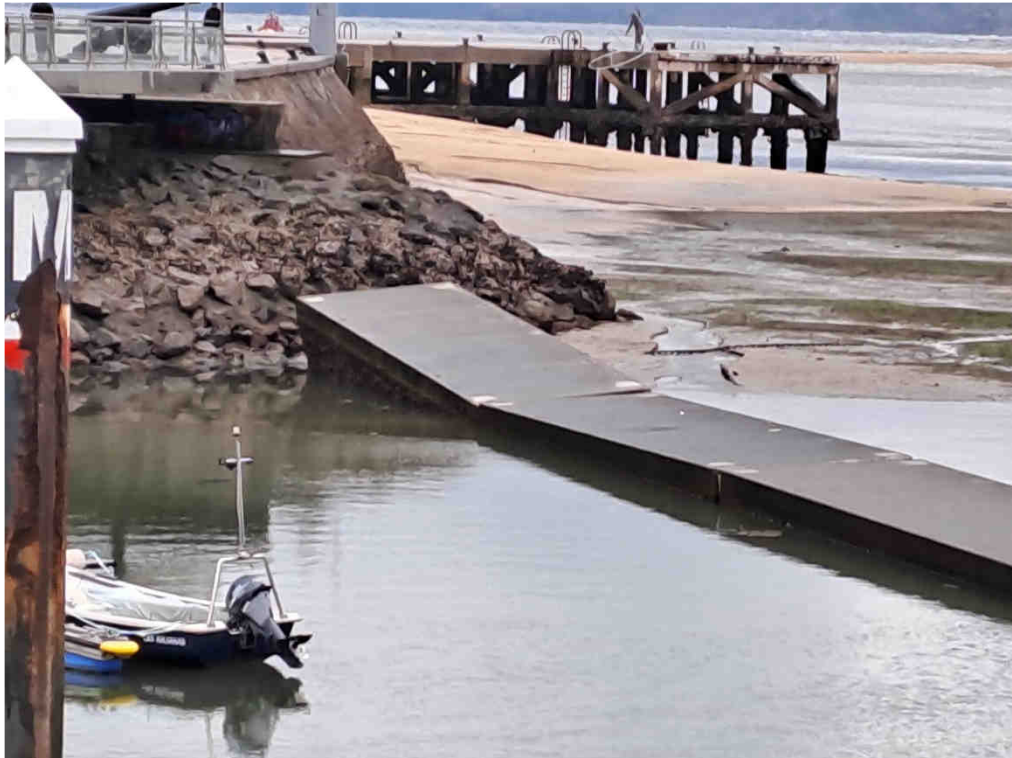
Detalles donde se aprecia el grado de inclinación del rompeolas de hormigón varado
